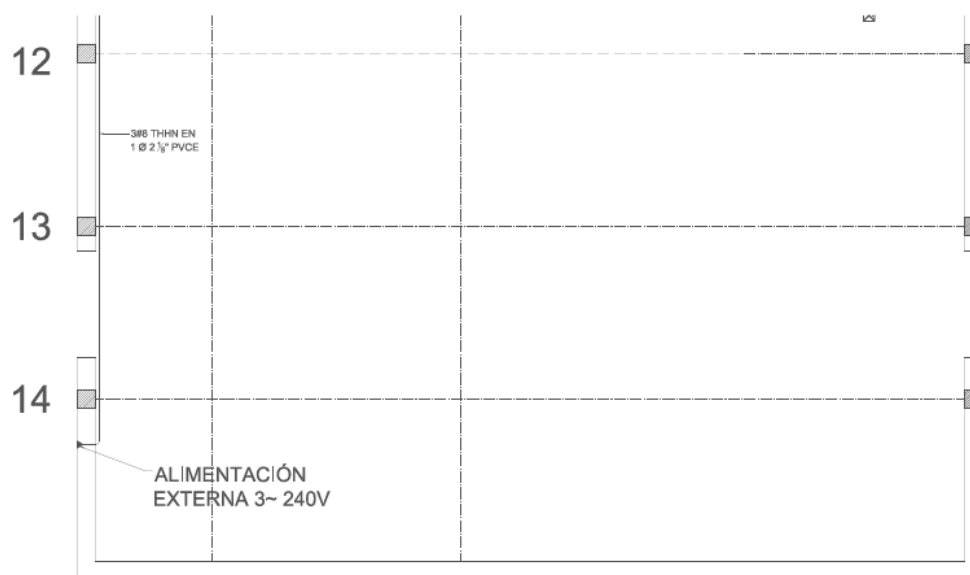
Plano de Potencia. Vista de los ejes del 12 al 14.
